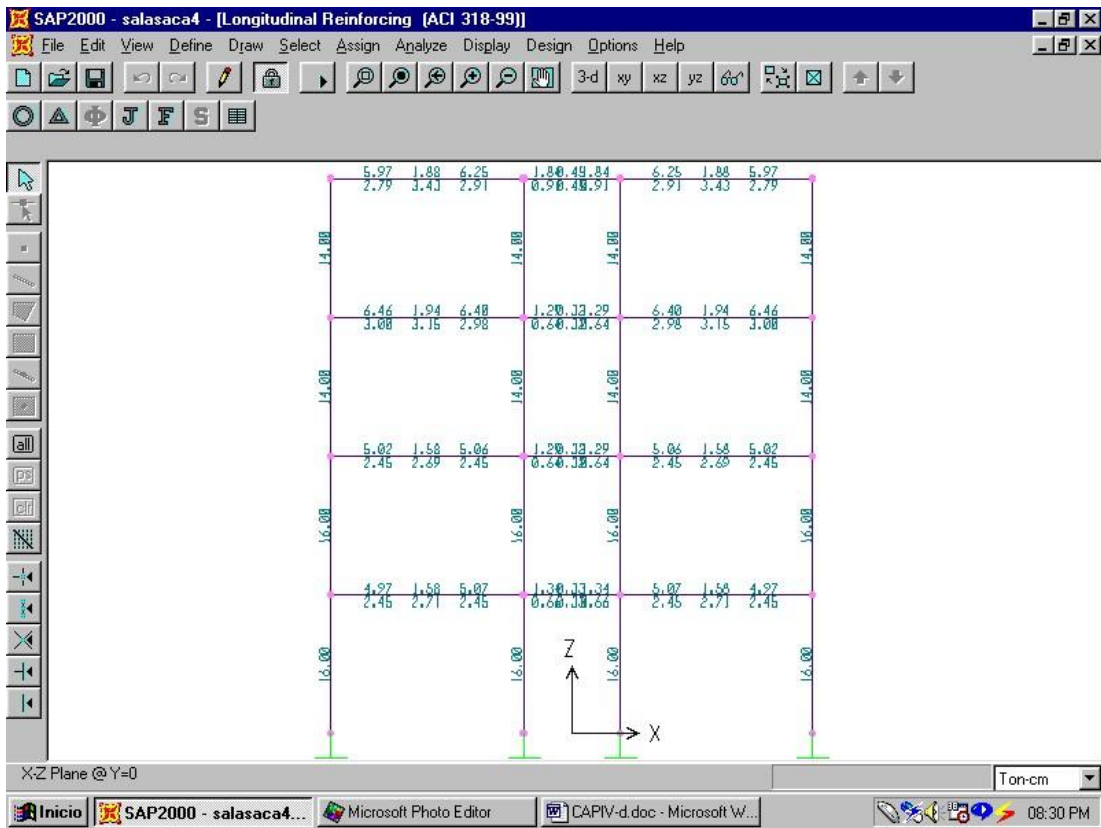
Reforzamiento longitudinal ACI 318-99 (vigas y columnas).
